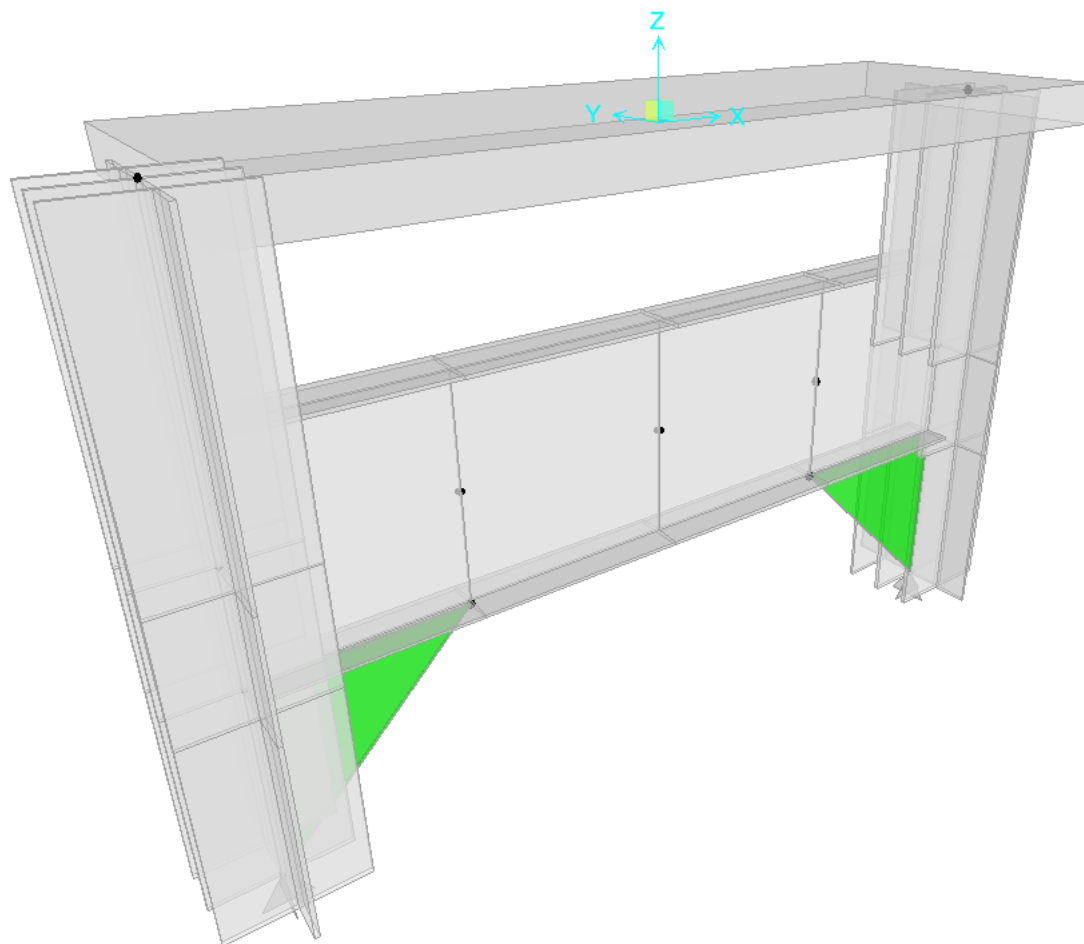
Telaio trasversale per il calcolo delle sollecitazioni sul traverso
